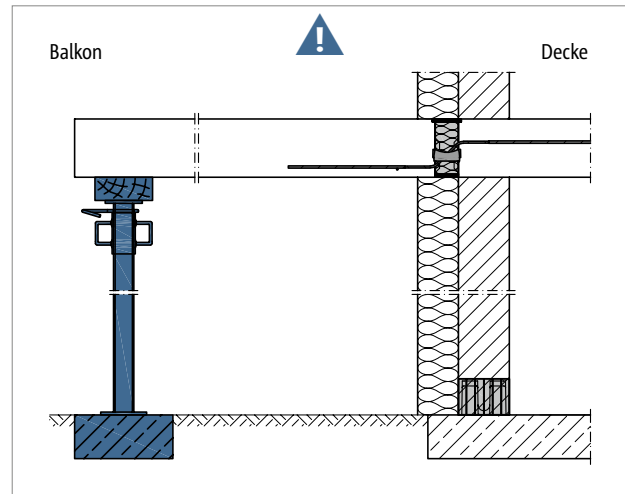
Schöck Isokorb® T Typ QL: Stützung durchgängig erforderlich
